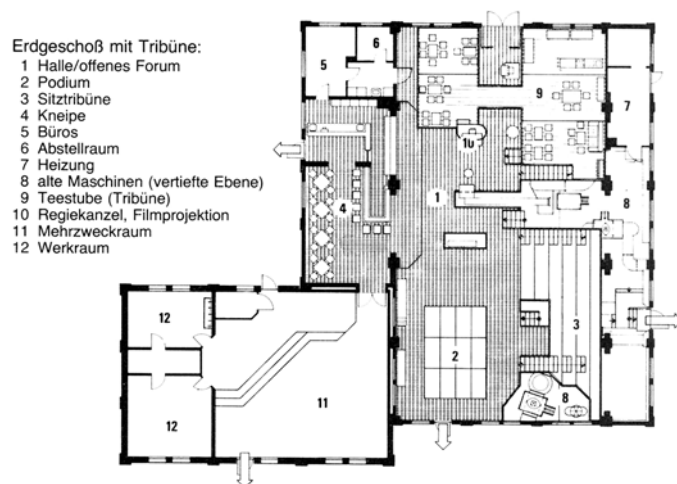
Pumpwerk*, Wilhelmshaven, Grundriß Erdgeschoß
